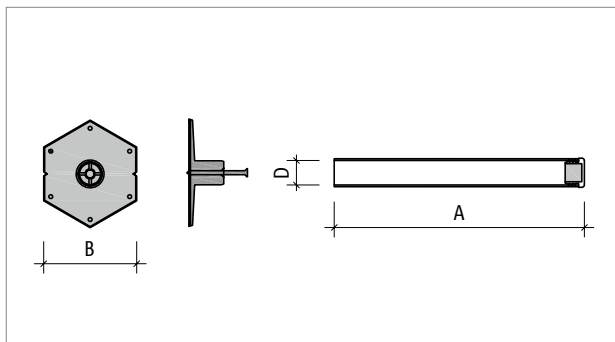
Schöck Stacon® type LD part S, LD part P: Dimensions of the sleeves made of stainless steel and plastic
